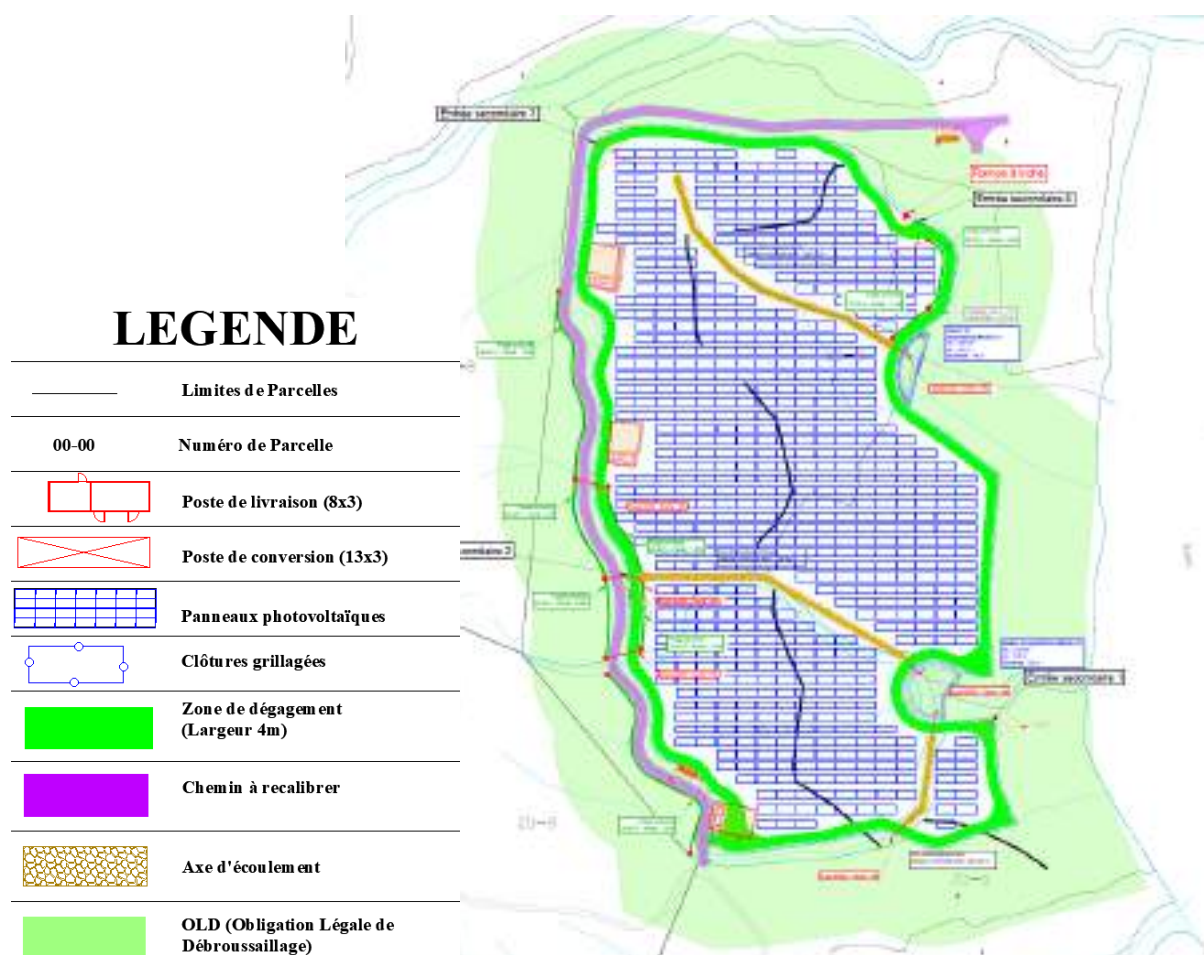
Extrait du plan de masse du projet (source : ENGIE Green)
